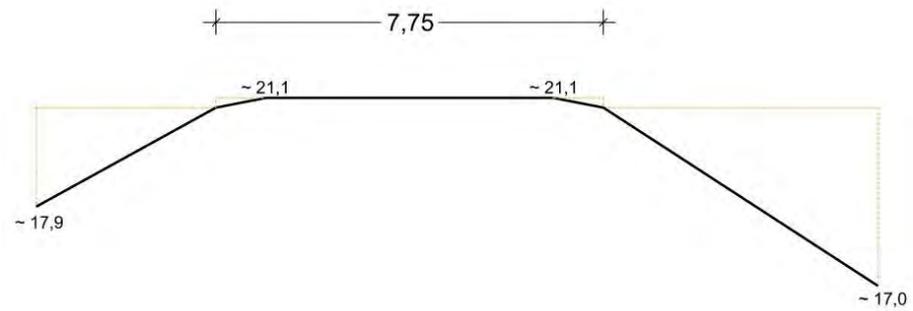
Querschnitt Q1 - Querprofil Bestand
